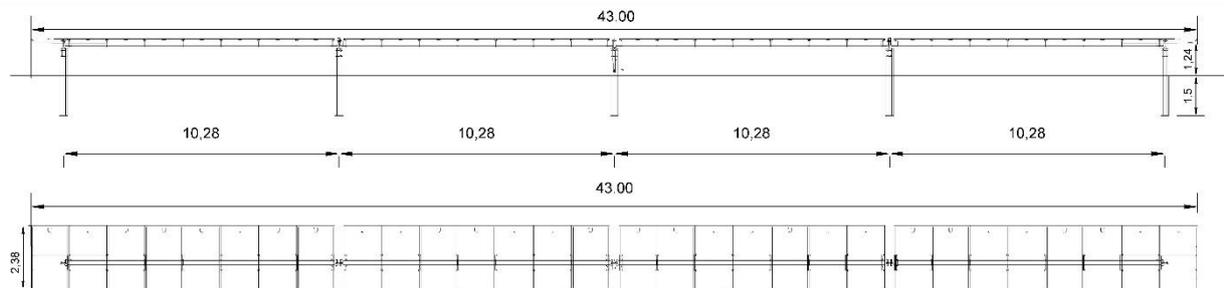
Prospetto frontale e vista in pianta delle strutture (30 moduli) ad inclinazione 0°
